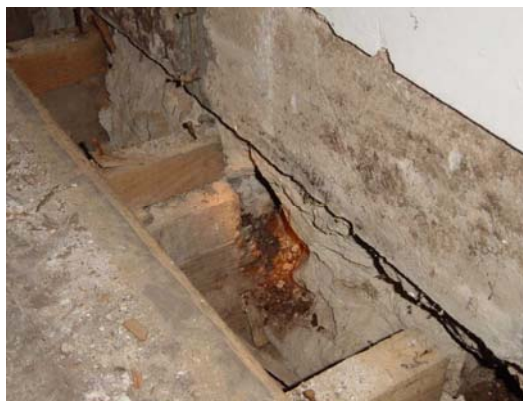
Apoios das vigas de pavimento deterioradas – 2º piso
